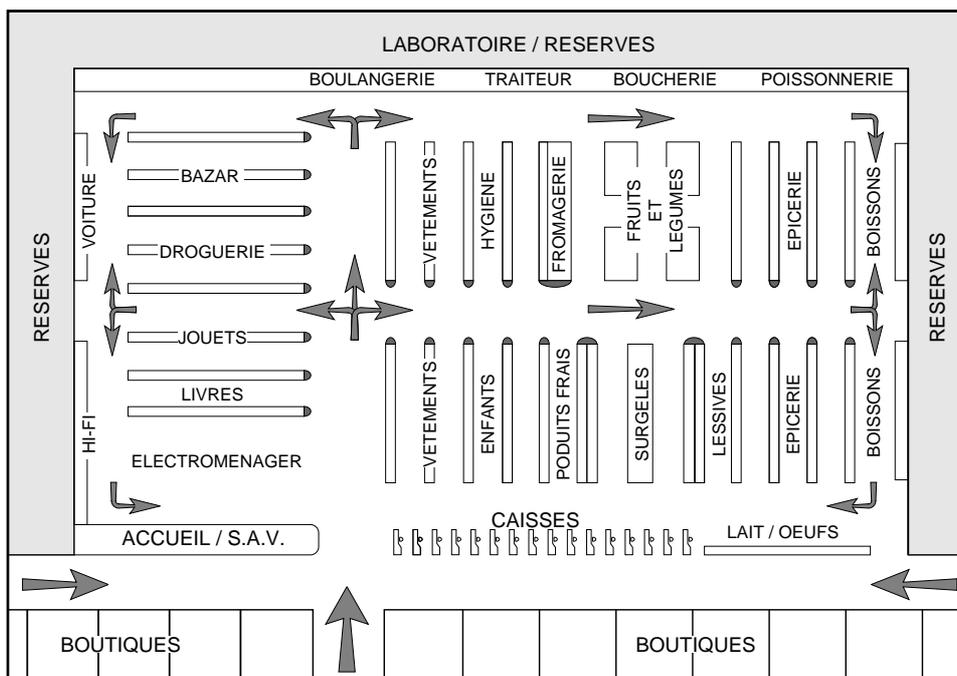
Plan type d'une grande surface (hypermarché)
